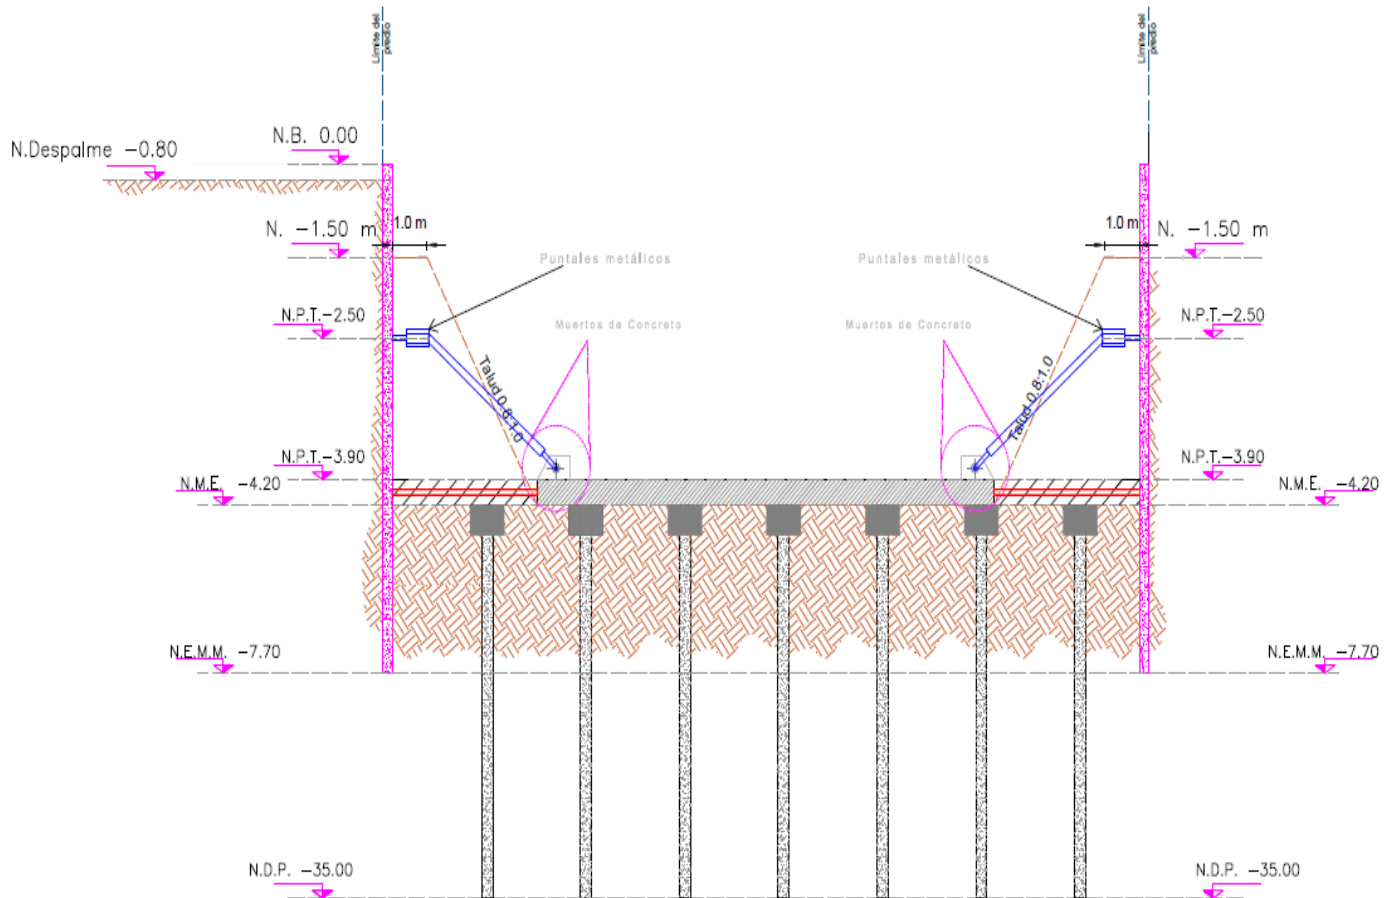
TROQUELAMIENTO DEL MURO MILÁN Y CONSTRUCCIÓN DE LOSA PERIMETRAL
